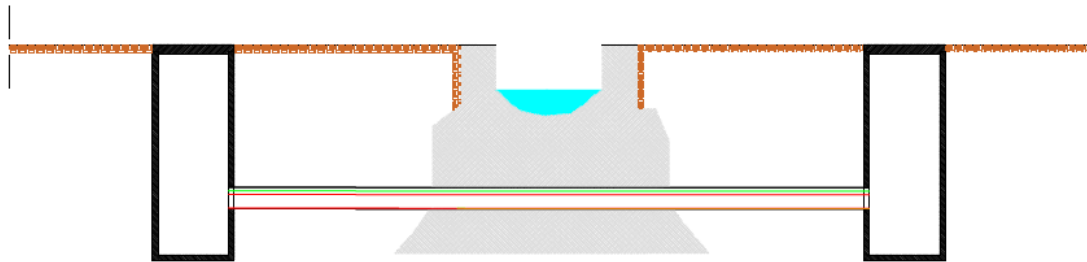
Sezione tipo attraversamento con tecnica spingitubo.
